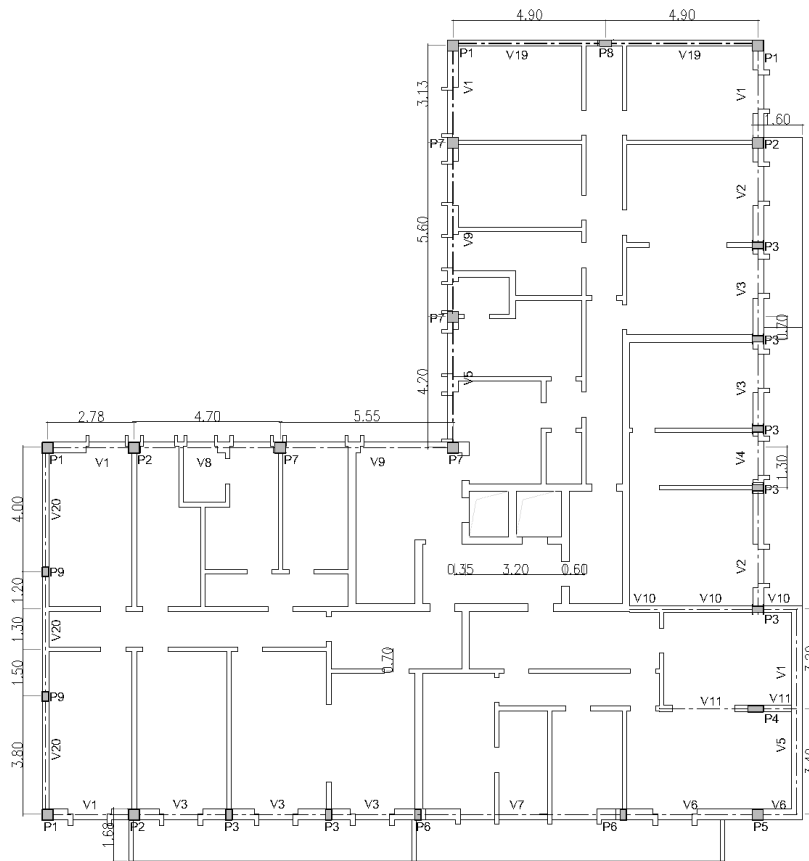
Planta de estabilidade do 1º andar (Piso 2)
